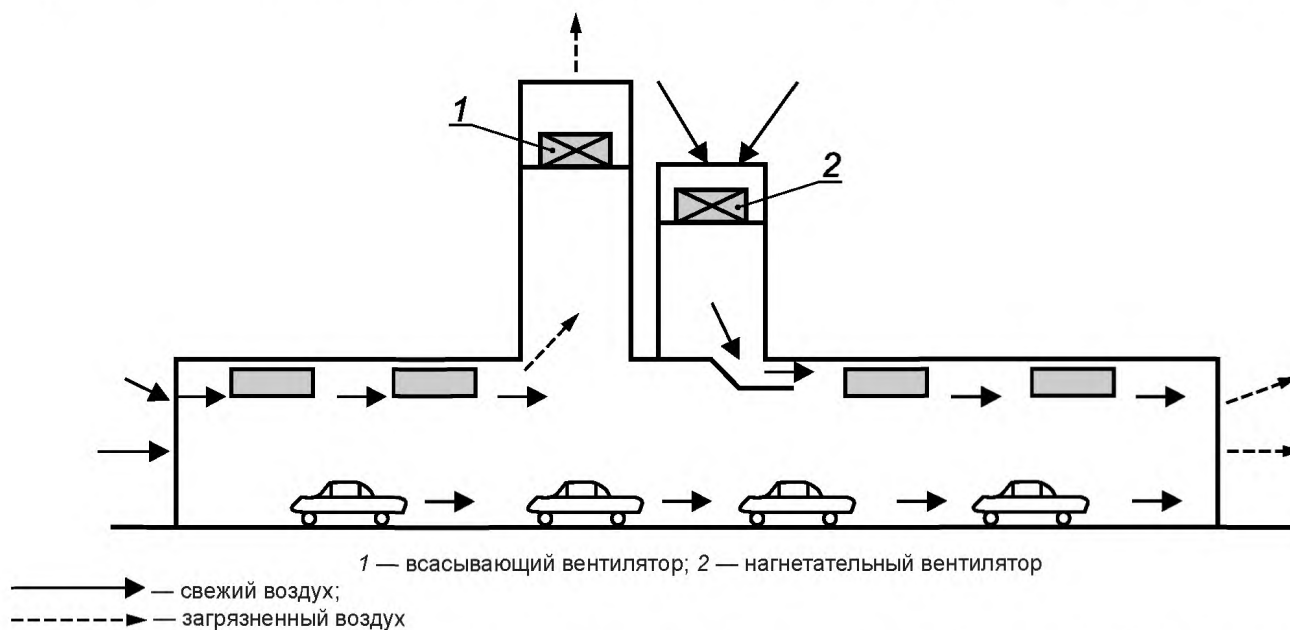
Схема вентиляции при полной или частичной замене воздуха по длине тоннеля
